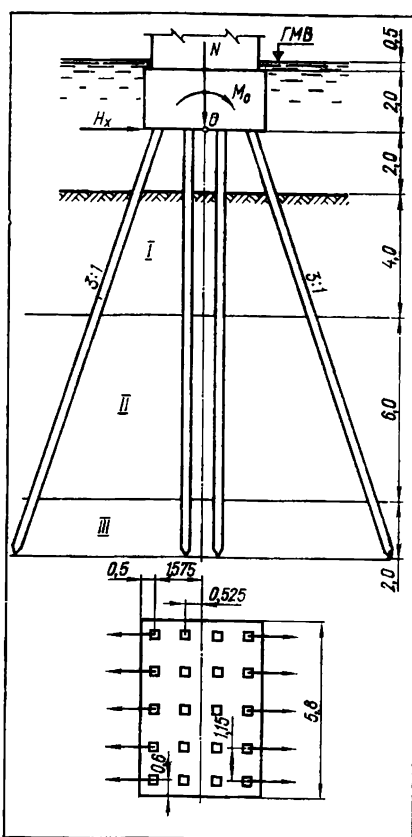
Схема фундамента с высоким свайным ростверком и наклонными сваями сечением 35×35 см: I — песок мелкий; II — суглинок; III — глина твердая.
